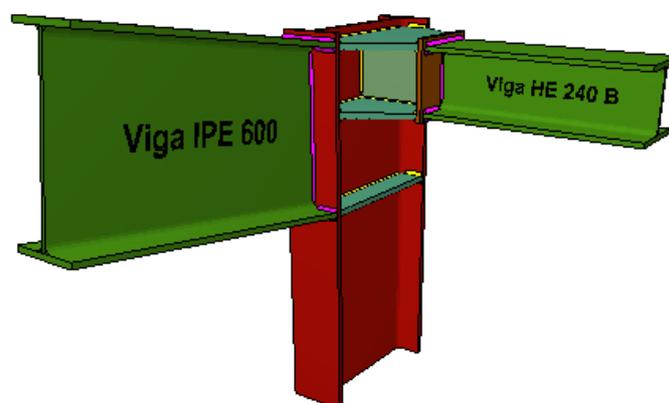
Soldadura S2. Fuente: CYPE 2017
